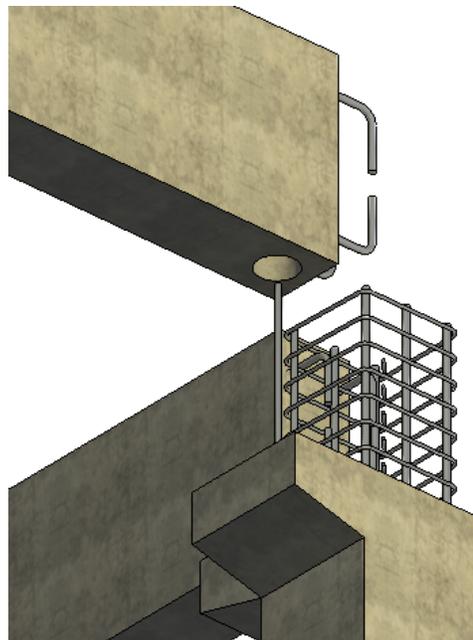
Ducto de empalme en viga, montaje referencial. Fuente: Elaboración propia.
